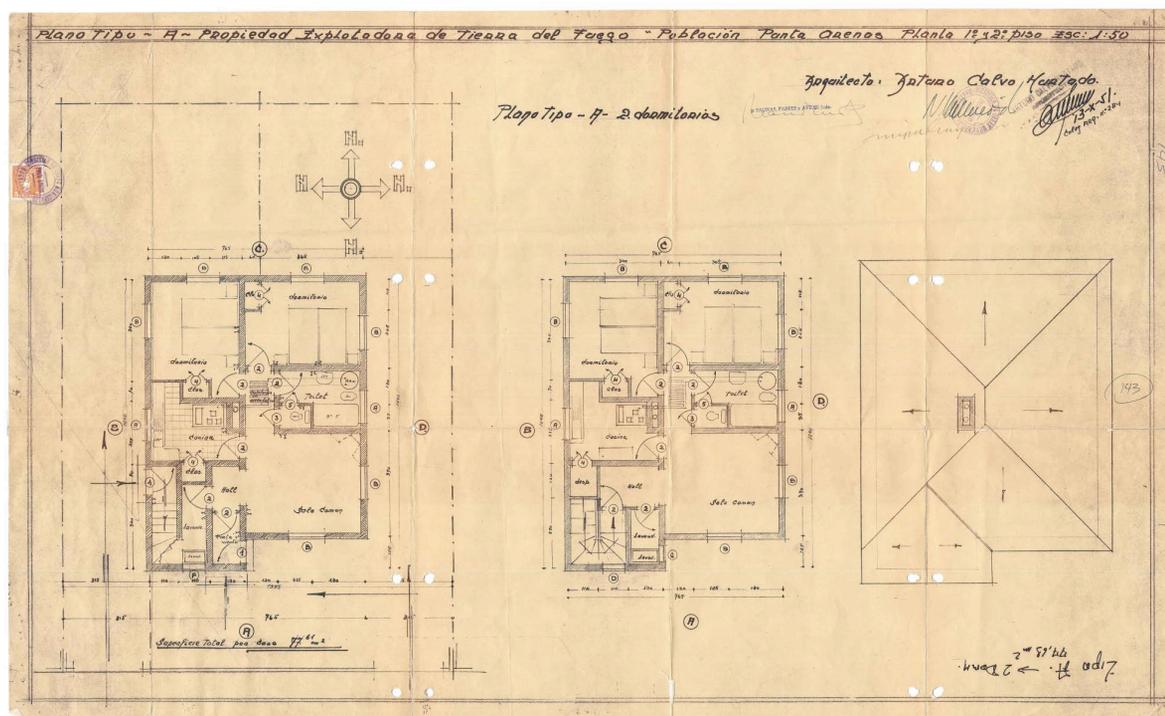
Plano de planta de arquitectura modelo Tipo A (Expediente N° 200 Población Explotadora, 1952).
